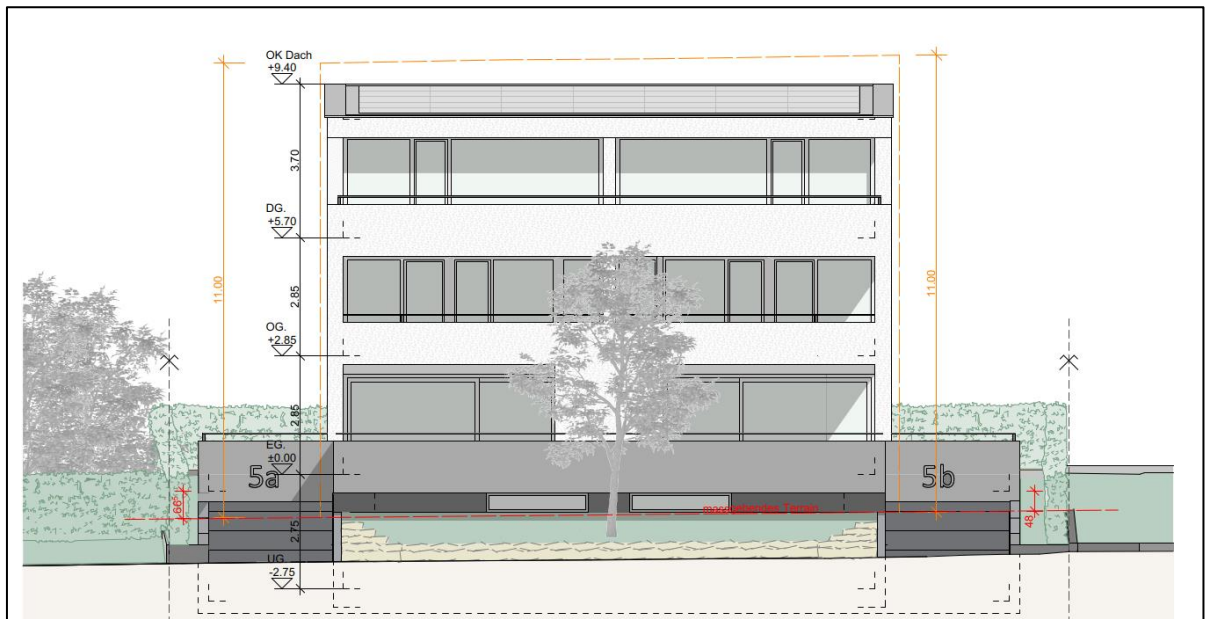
Nordwestfassade gemäss Plan "Fassaden" vom 13. Januar 2025
